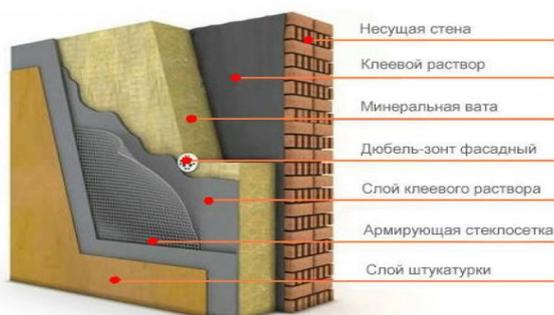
Способ дополнительного утепления стен с использованием армированной штукатурки.
